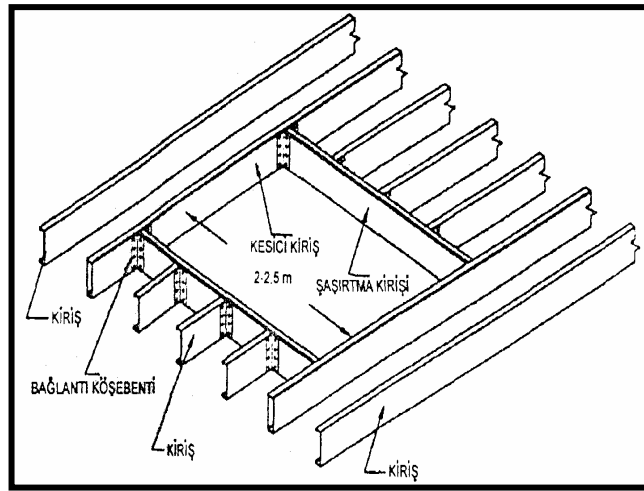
Hafif çelik konstrüksiyon döşeme detayı (Kenanoğlu 2000).
